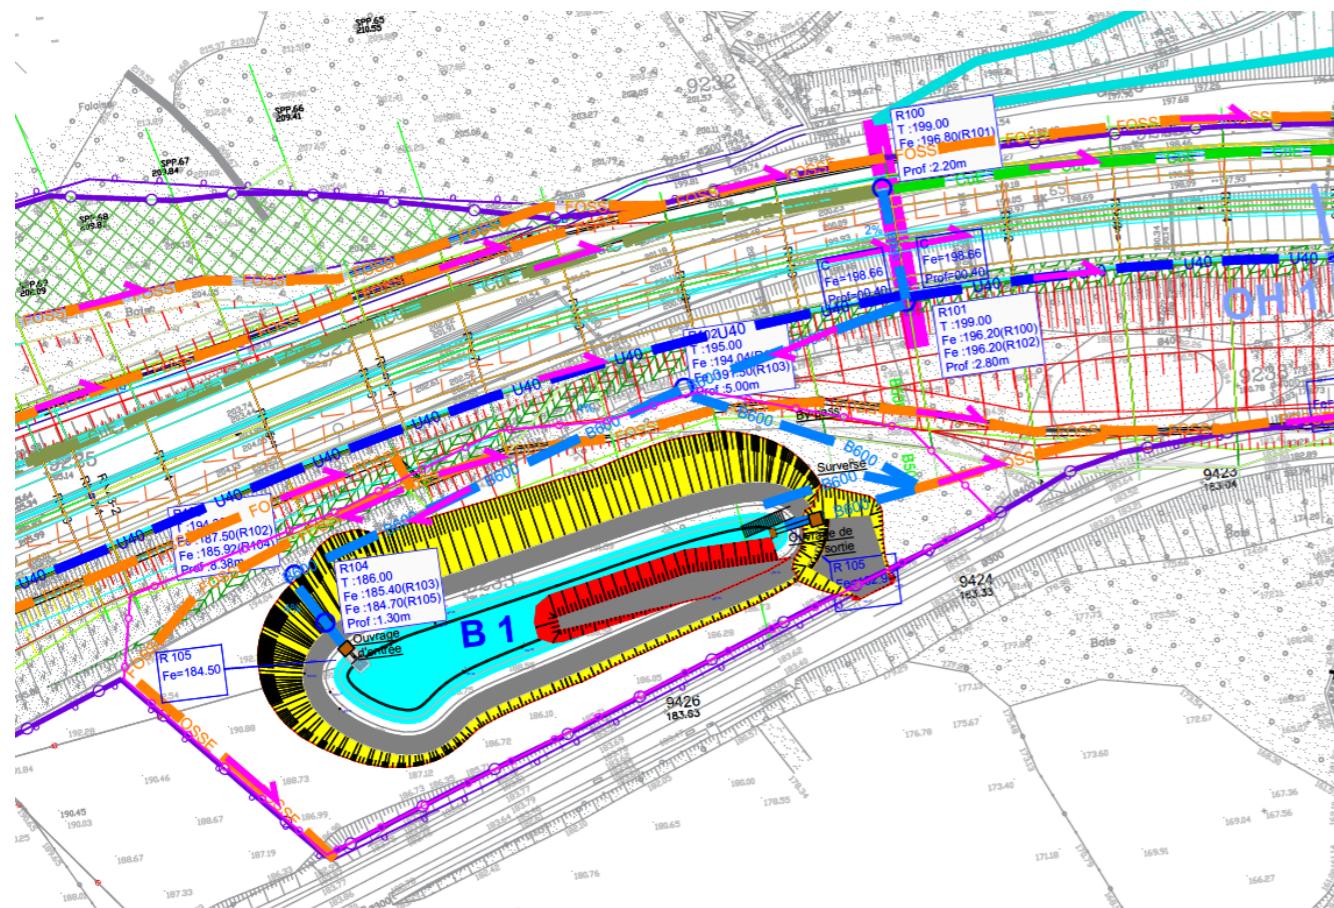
Plan d'assainissement du BR1 (source : SIR)
